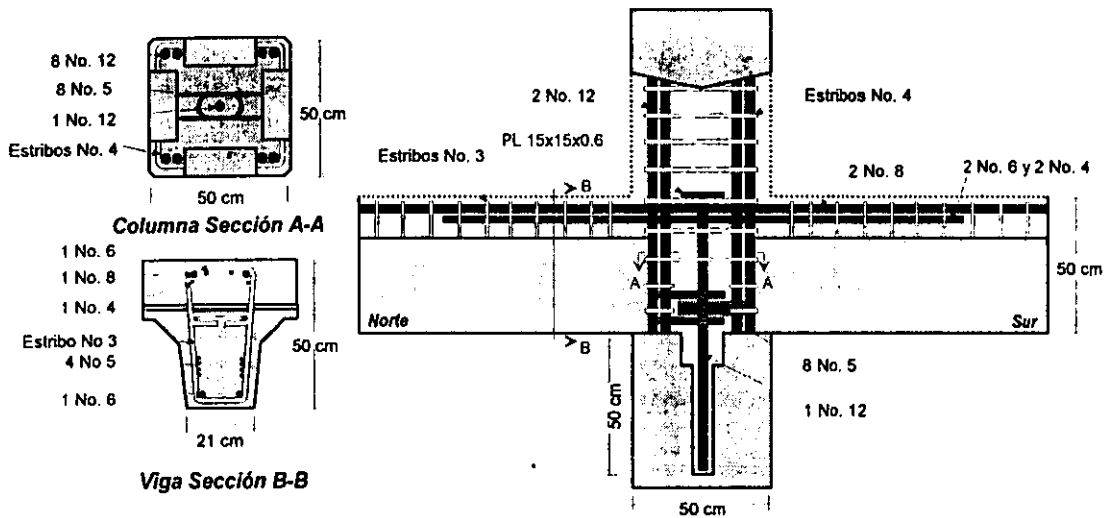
Detalles de la unión viga columna, dirección de rigidez
